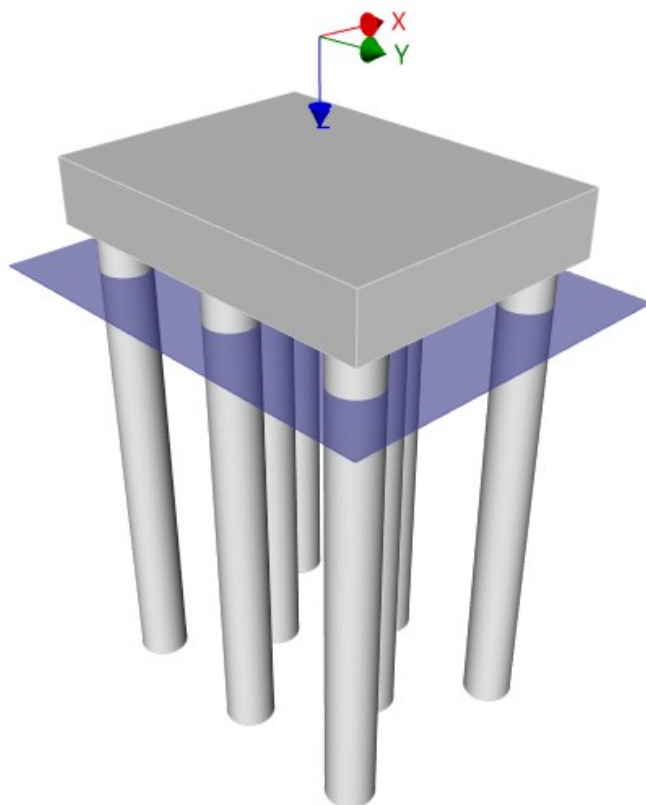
Modelo de calculo da fundação do pilar P5 (Geo5)
